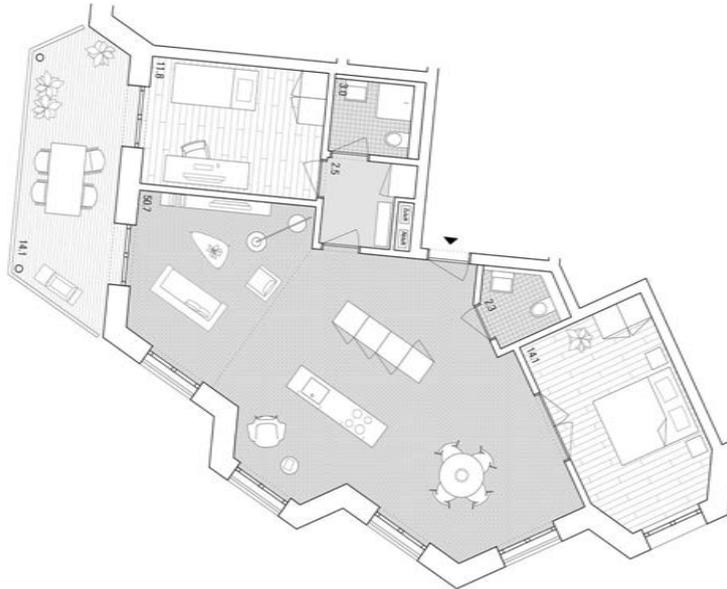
Wohnungsgrundriss 3.5 Zimmer - Whg.
